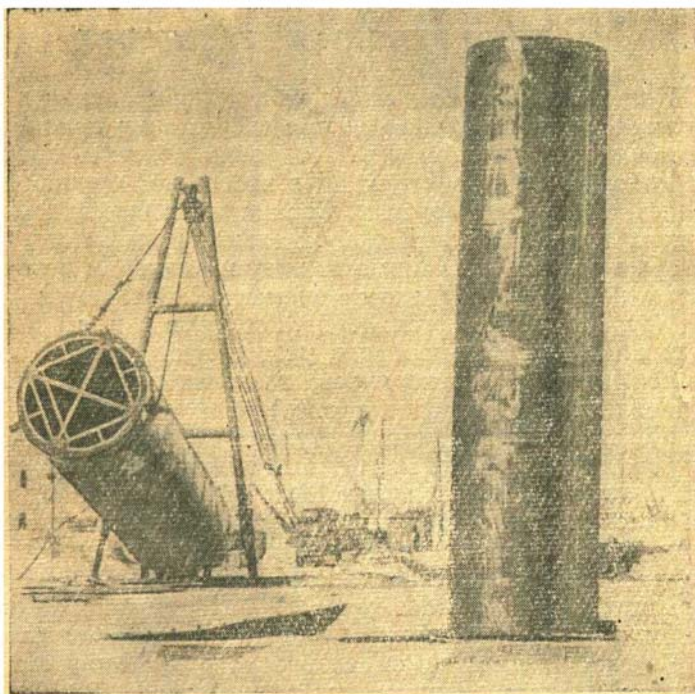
Подъем рулона корпуса газгольдера емкостью 6 000 м³.
